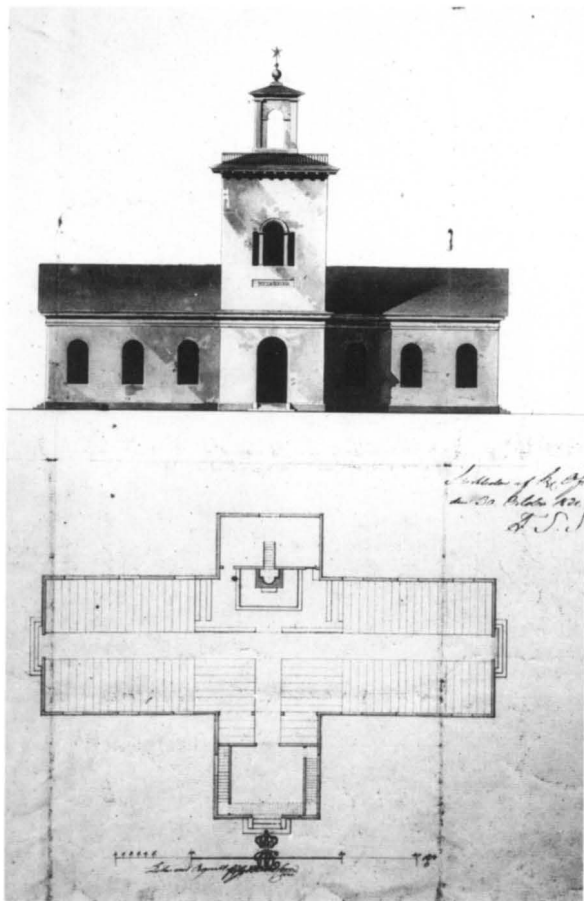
Överluleå kyrka. Plan och fasader, förslag av E Hollström 1824. RA.
